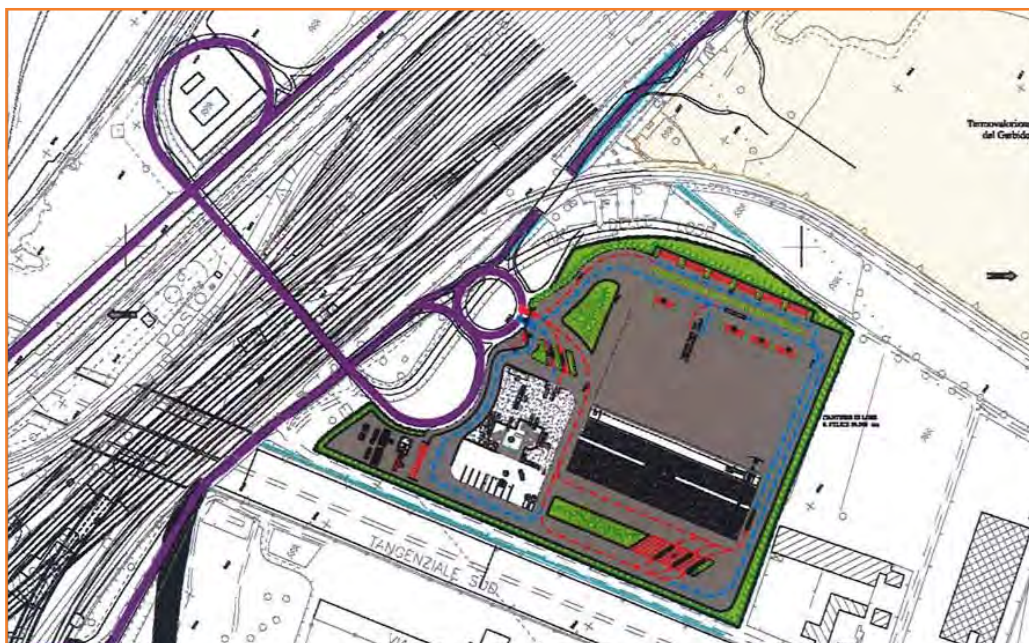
Schema funzionale nuovo cantiere Orbassano (Lose San Felice). Fonte: RFI-Italferr
